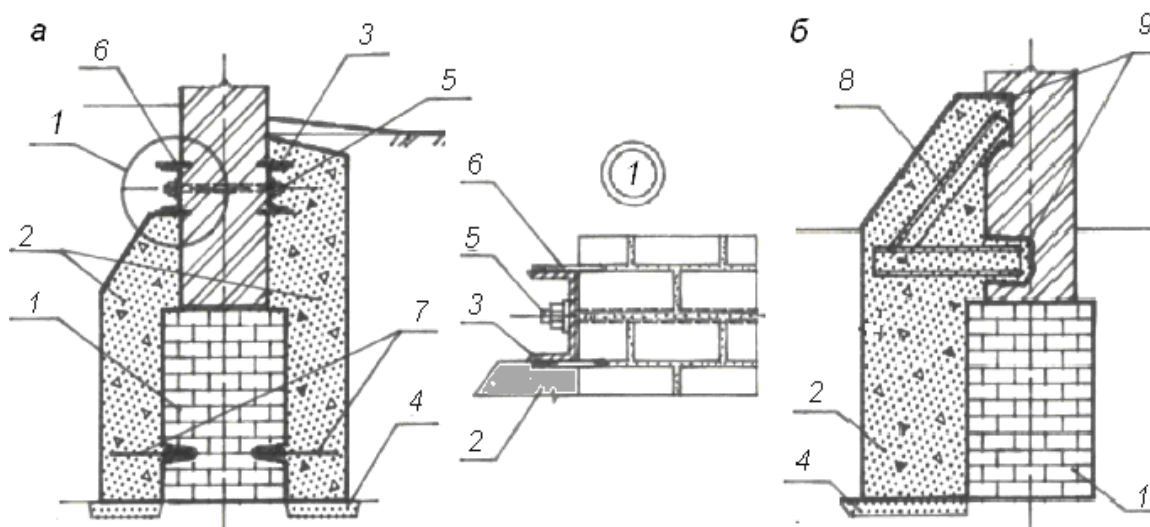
Уширение подошвы ленточного фундамента: *а* – двухсторонним наращиванием с опорными элементами в виде продольных балок; *б* – односторонним наращиванием с подкосами: 1 – существующий фундамента; 2 – наращивание; 3 – продольные металлические балки; 4 – подготовка, 5 – стяжной болт; 6 – плоские металлические зубья; 7 – анкер, 8 – стальной подкос; 9 – бетон
